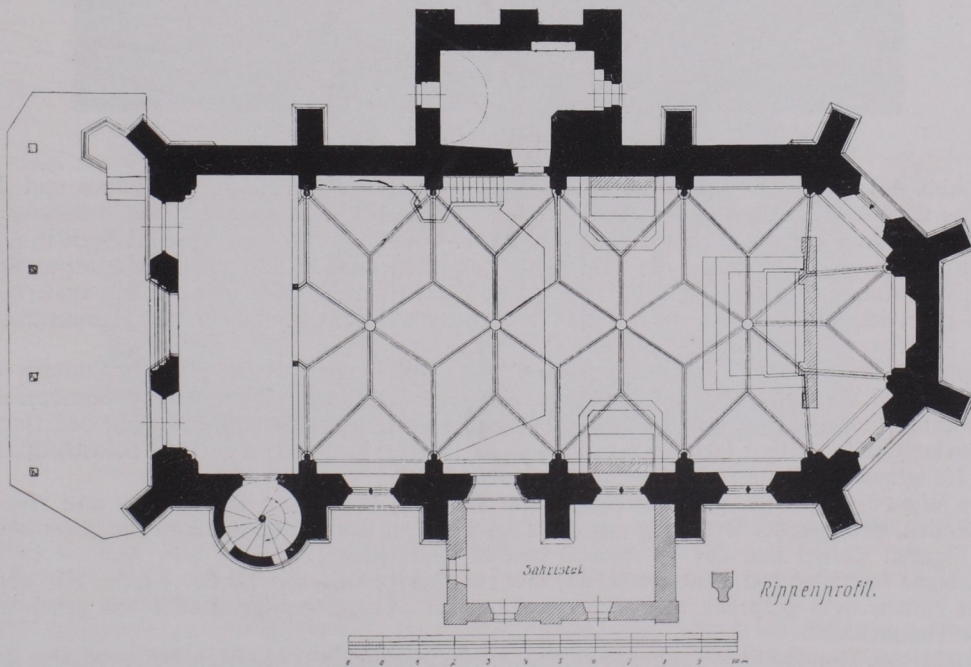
St. Margarethen, Filialkirche, Grundriß 1:200 (S. 49).
